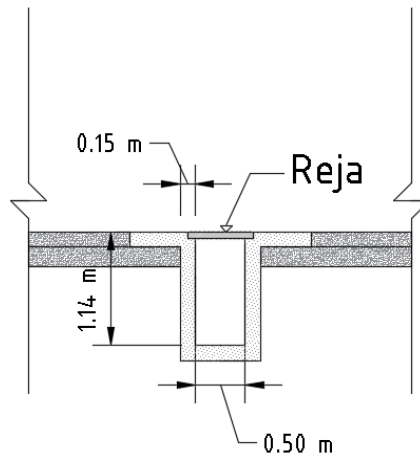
Sección tipo albañal Arribeños intersección Catamarca.
